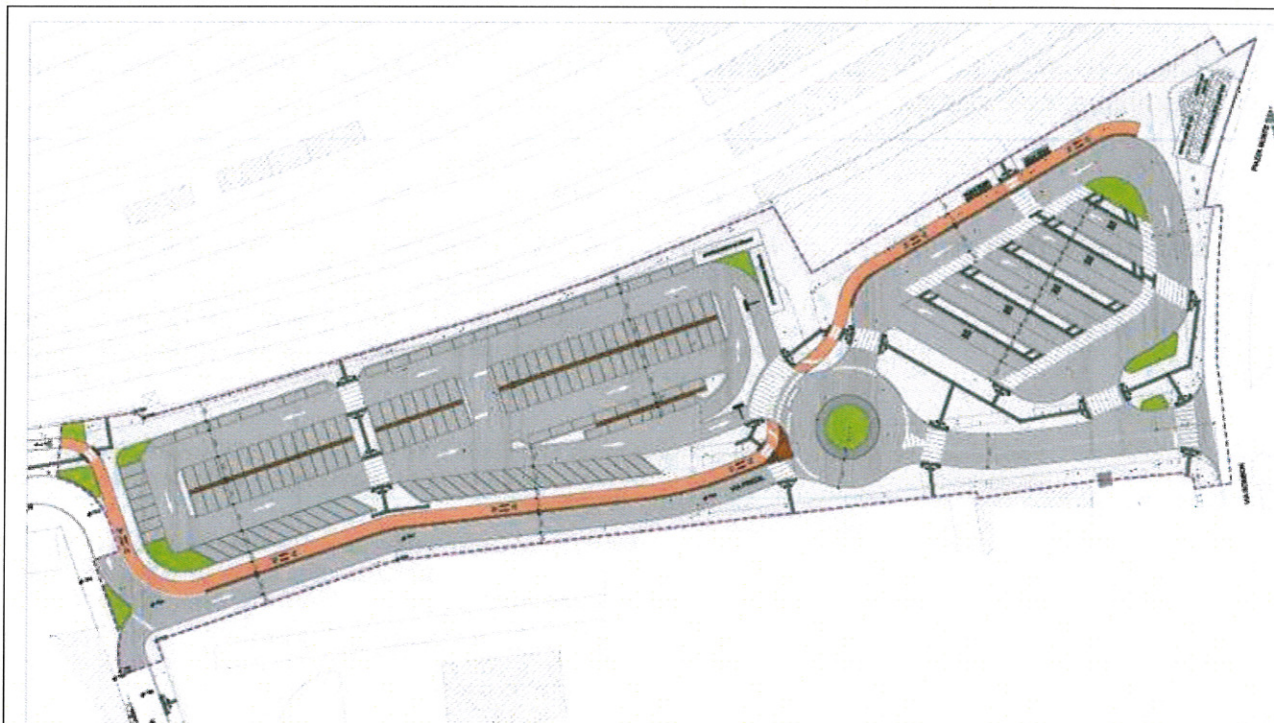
planimetria di progetto dell'intervento sulla piazza Monte Titano
